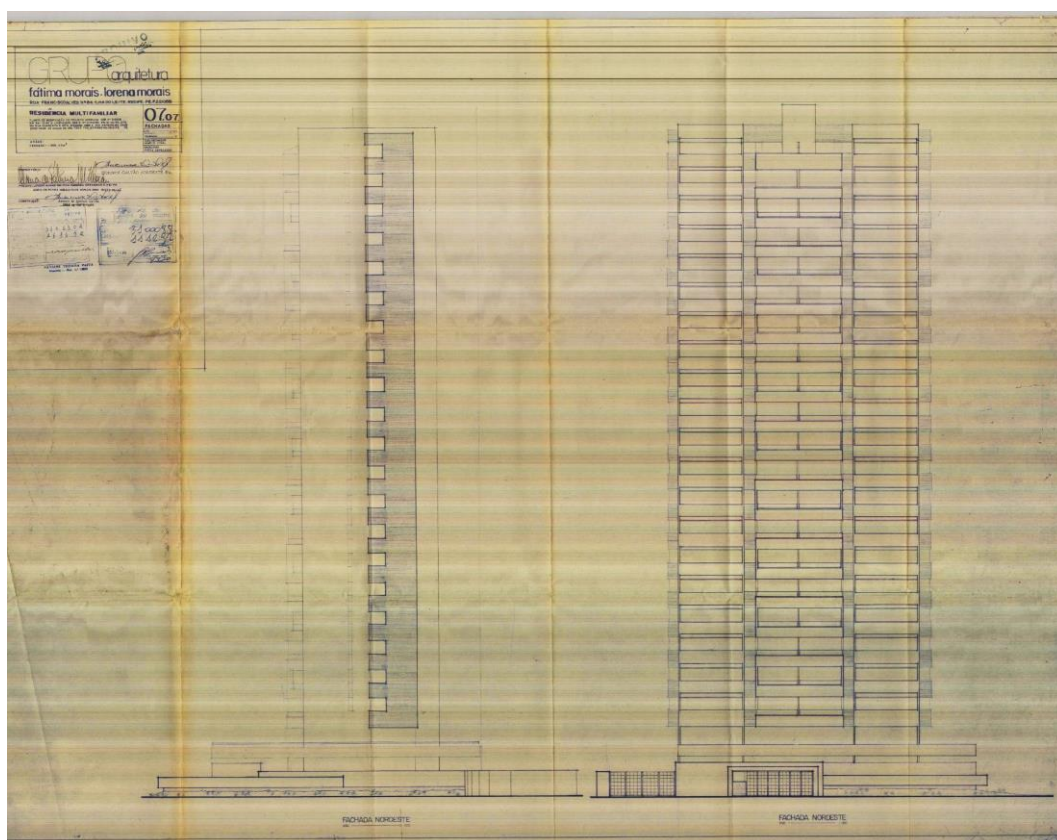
Fachadas principais do edifício Maria Tereza, 1987, Grupo Arquitetura.
